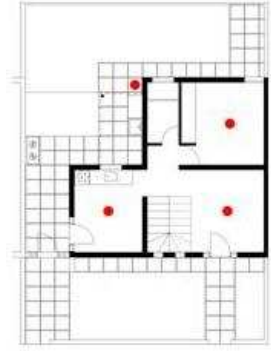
Plano de ubicación de los sensores en la planta baja y exterior
